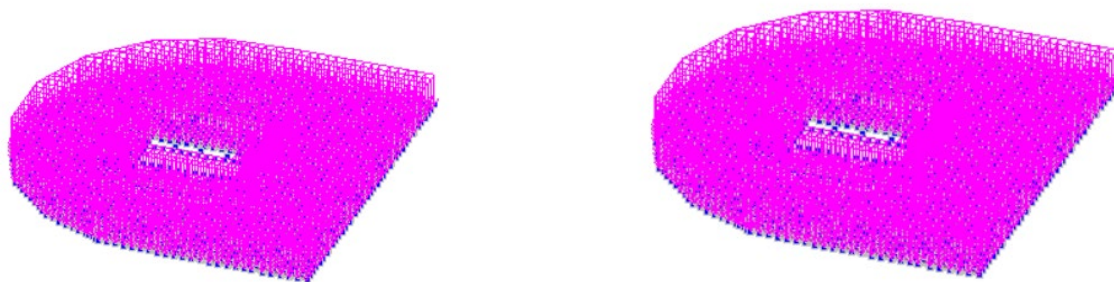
Нагрузка от перегородок; рис. 3.4а – Нагрузка от собственного веса
